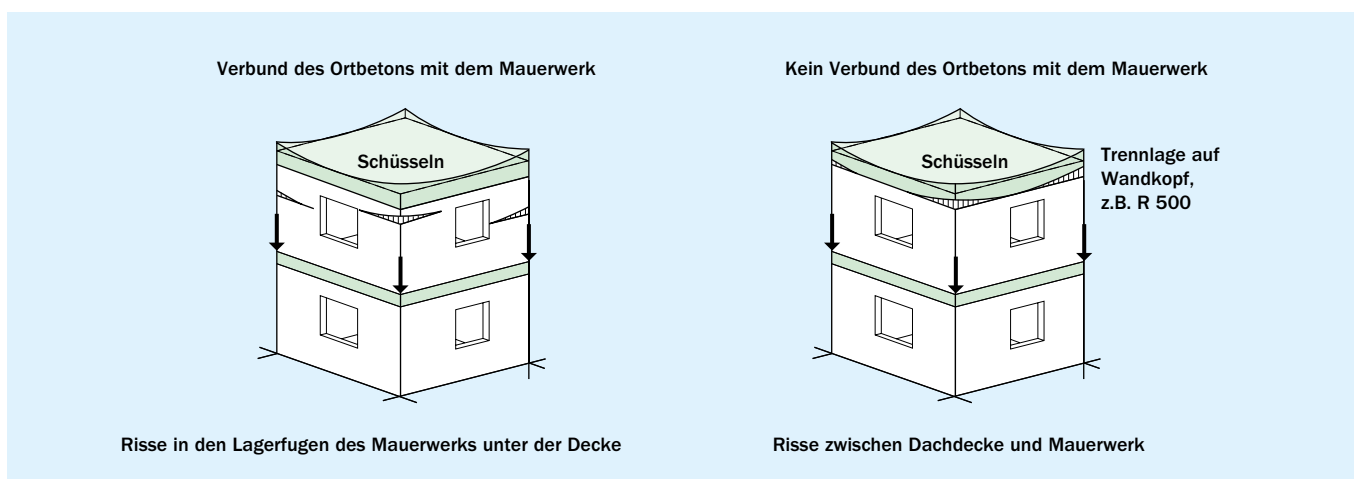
Eckabhebung der Dachdecke – Risse im Mauerwerk und zwischen Mauerwerk und Decke
